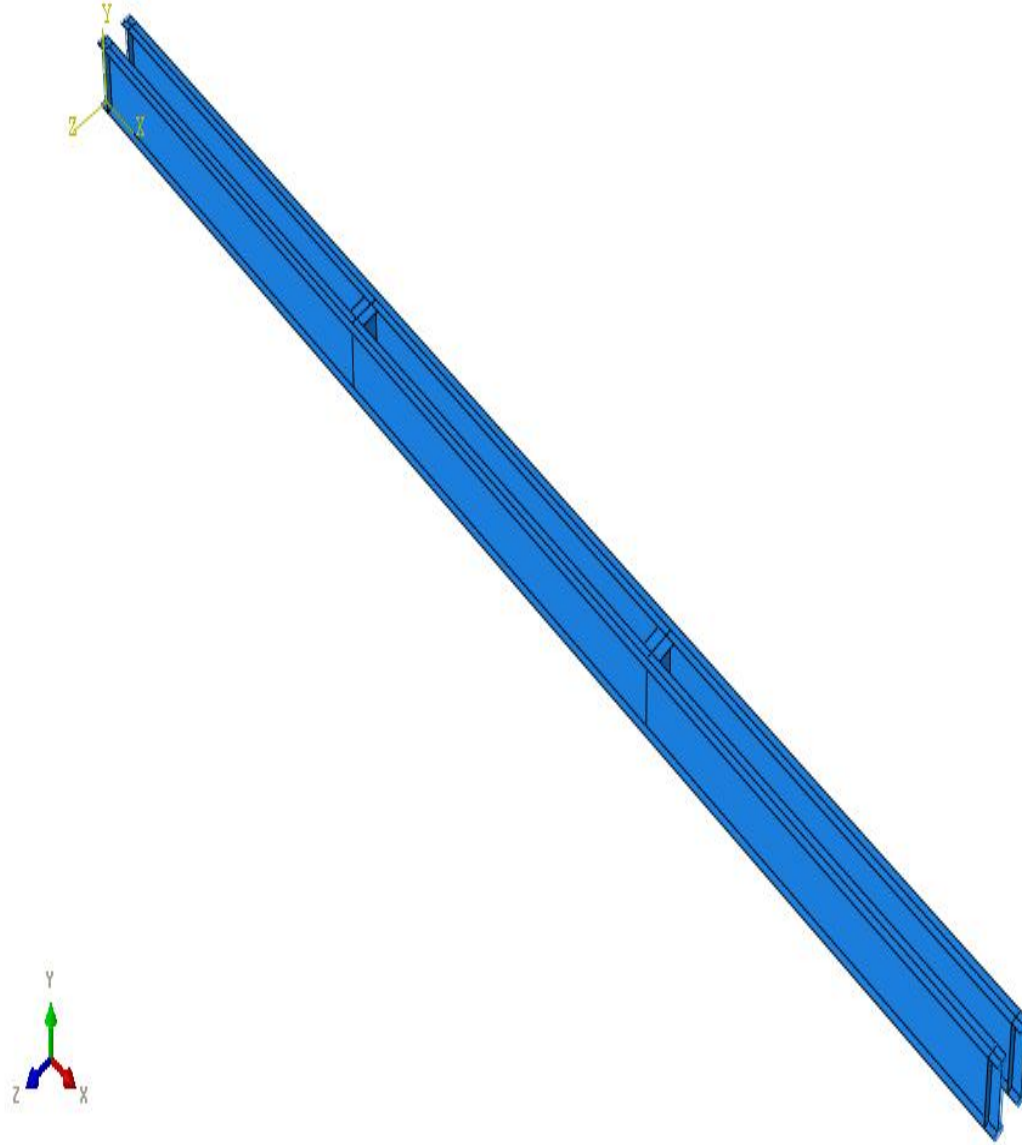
Çift I enkesitli çok parçalı kirişlere ait ara bağlantı detayı.
